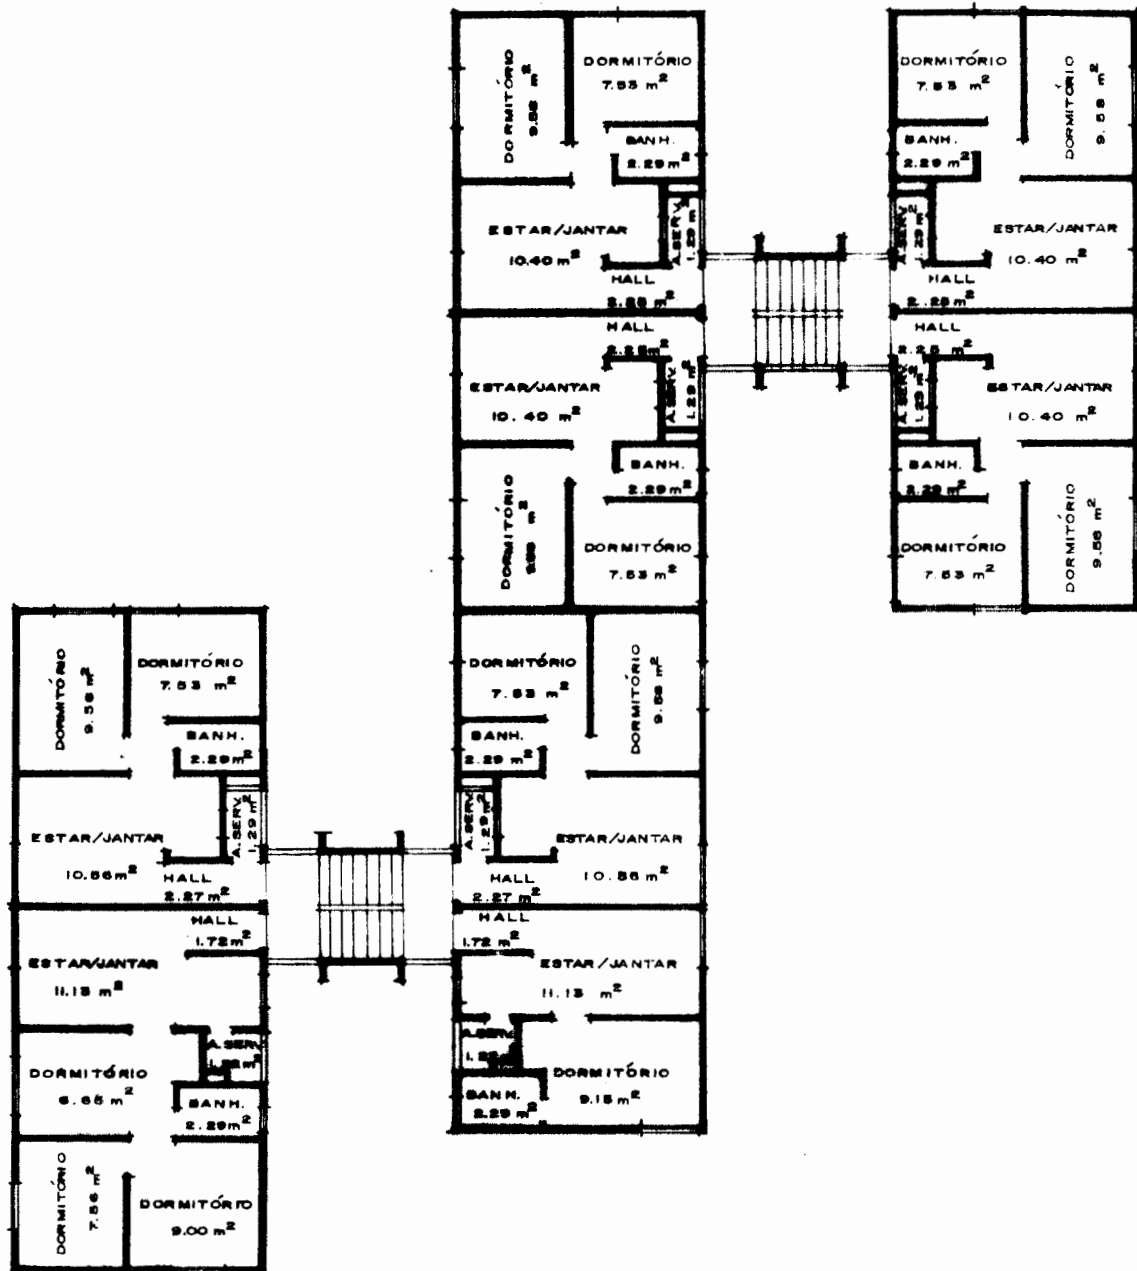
Pavimento tipo bloco de apartamentos Conjunto Rubem Berta
